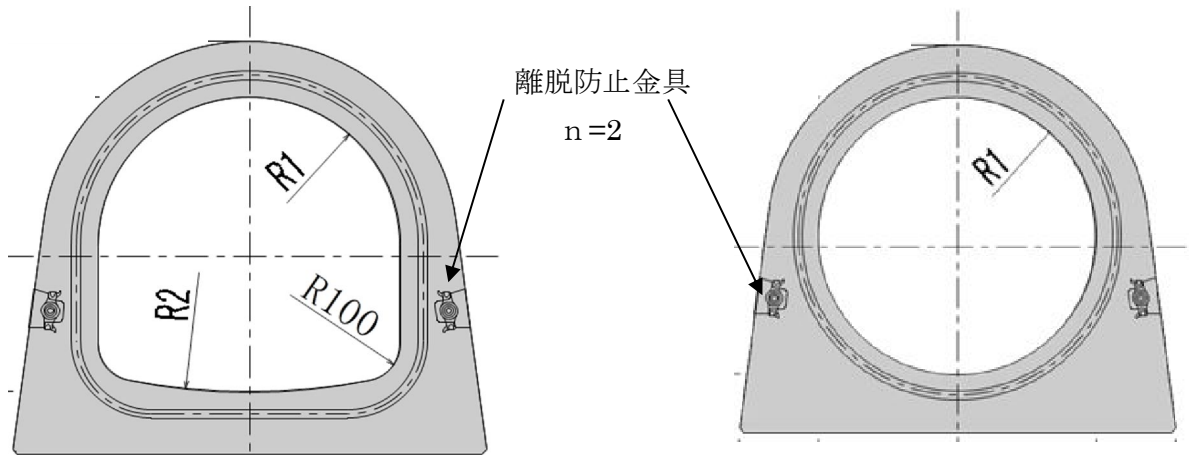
撓み性可とう離脱防止ジョイント配置図
